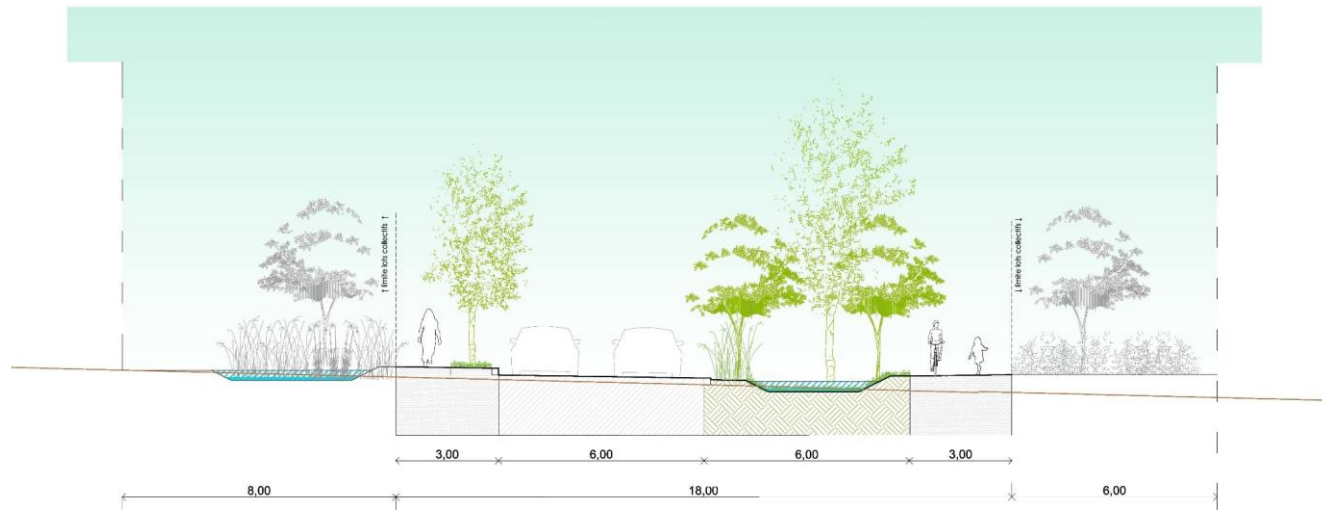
Profil voie principale (Source : LA PLAGE – Mars 2025)
